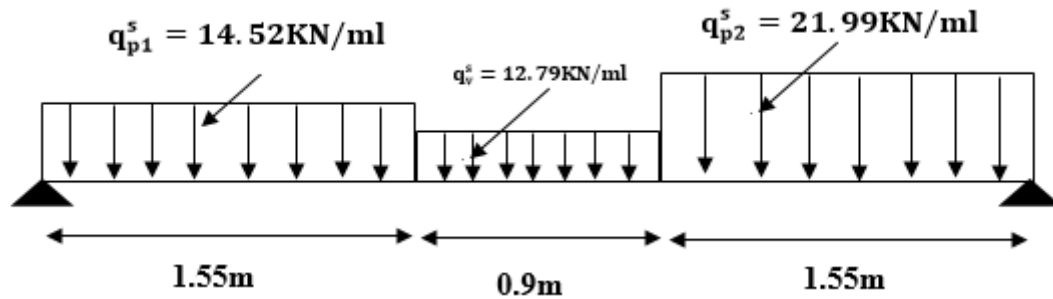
Schéma statique de la poutre brisée à l'ELS.
